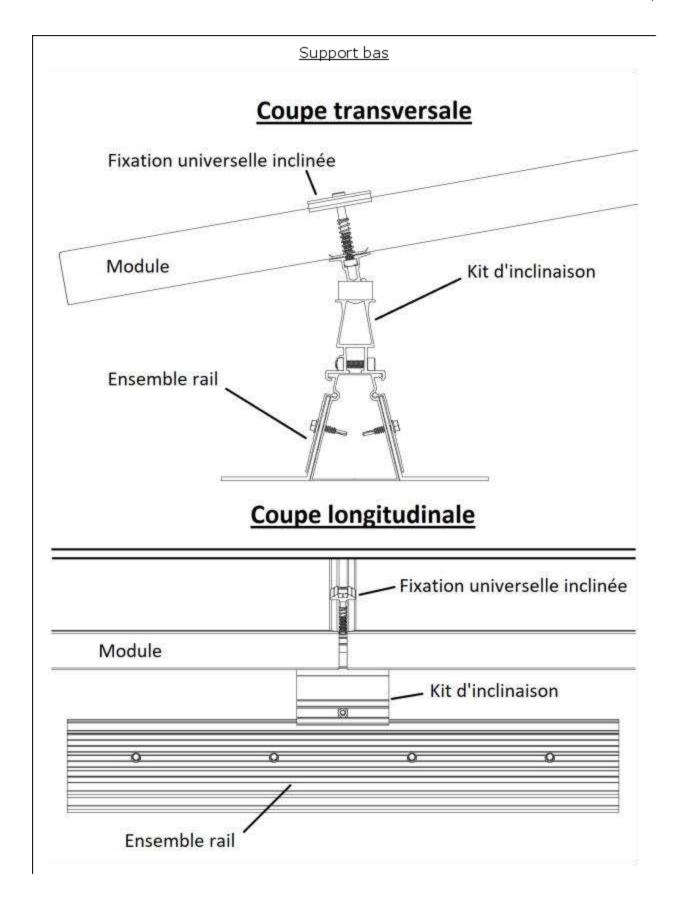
(suite) - Assemblage rail / kit d'inclinaison / module
